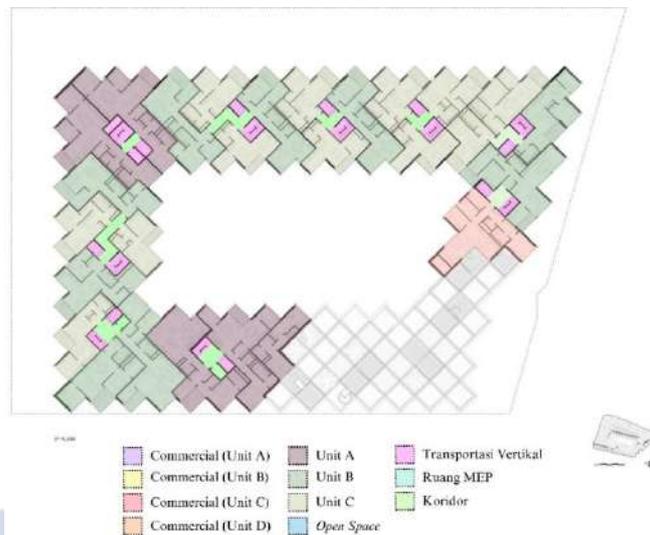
Denah *Ground Floor* 79 & Park Residences
